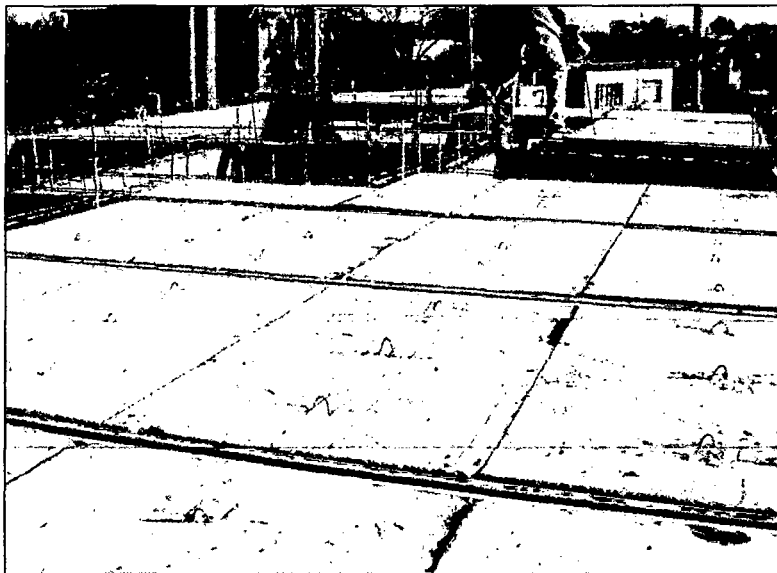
= Colocación de unidades de concreto celular en la losa del 1er. nivel.
